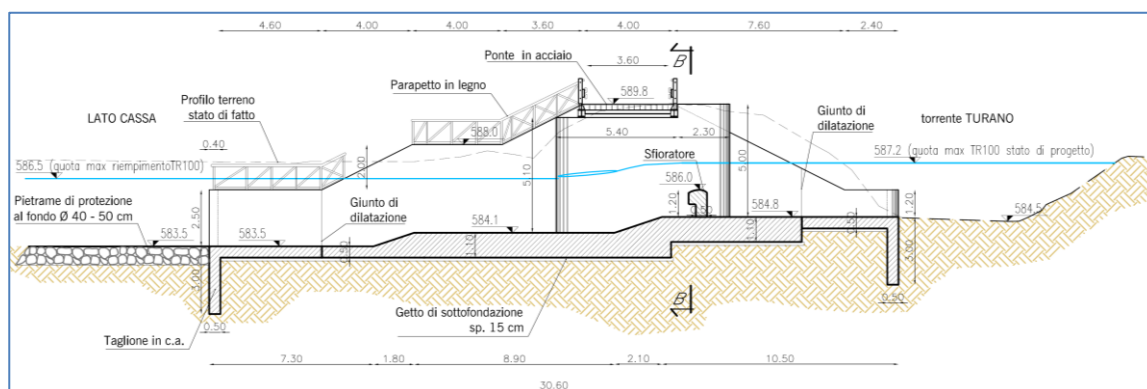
Cassa sul T. Turano. Sezione longitudinale della traversa di regolazione.
